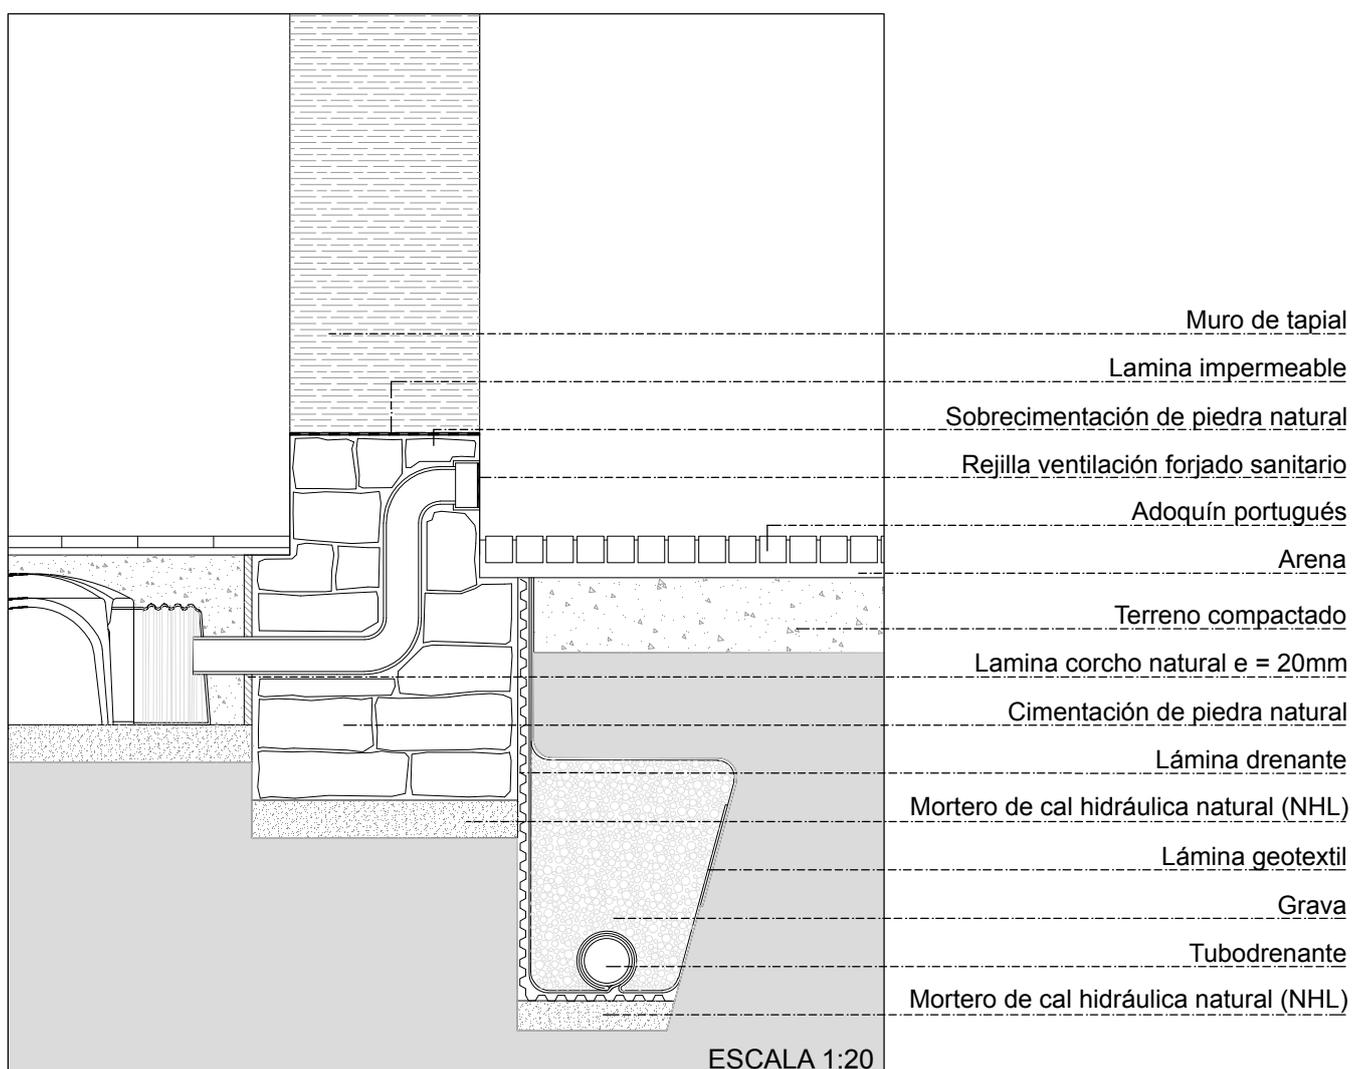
Detalle constructivo: cimentación. 2018. Fuente propia.
